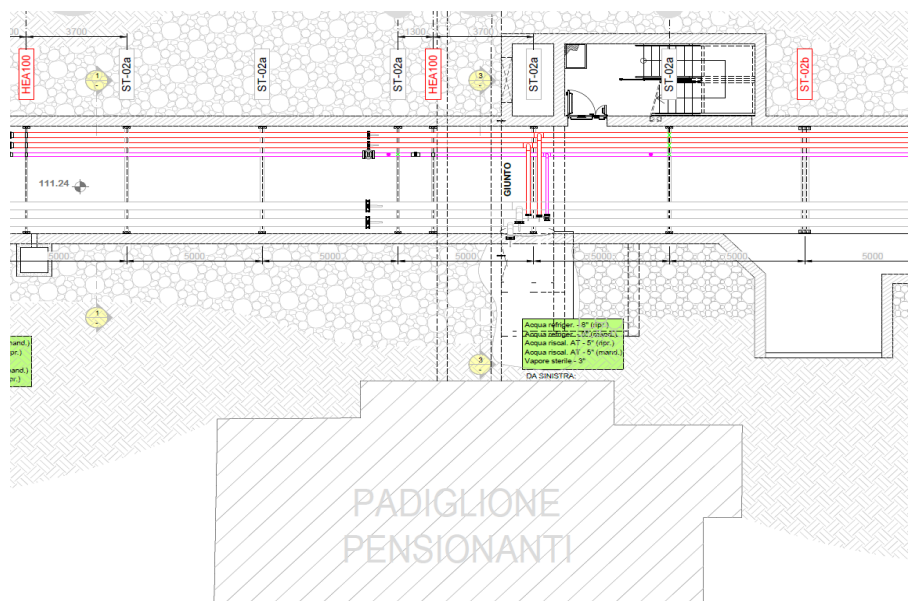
Estratto pianta gallerie tecniche fronte pad. 6
